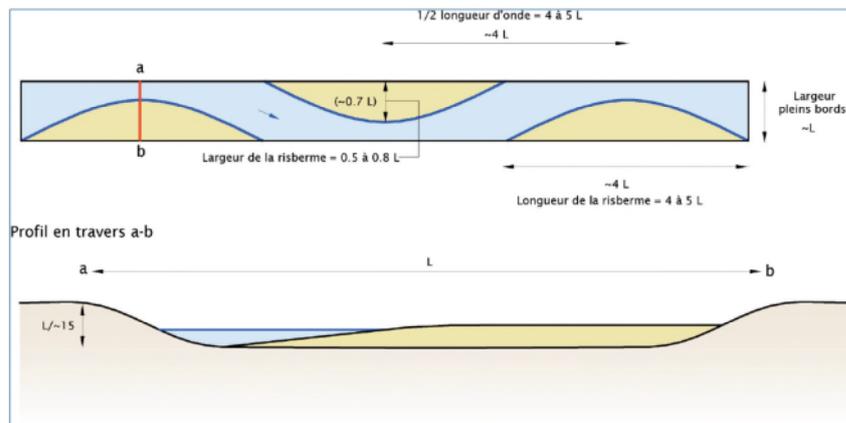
Coupe et plan de principe d'aménagement de banquettes végétalisées
